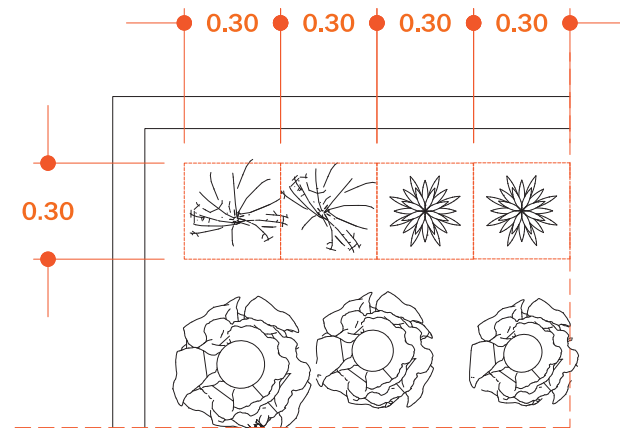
Separación entre plantas. Elaboró DAJM.
